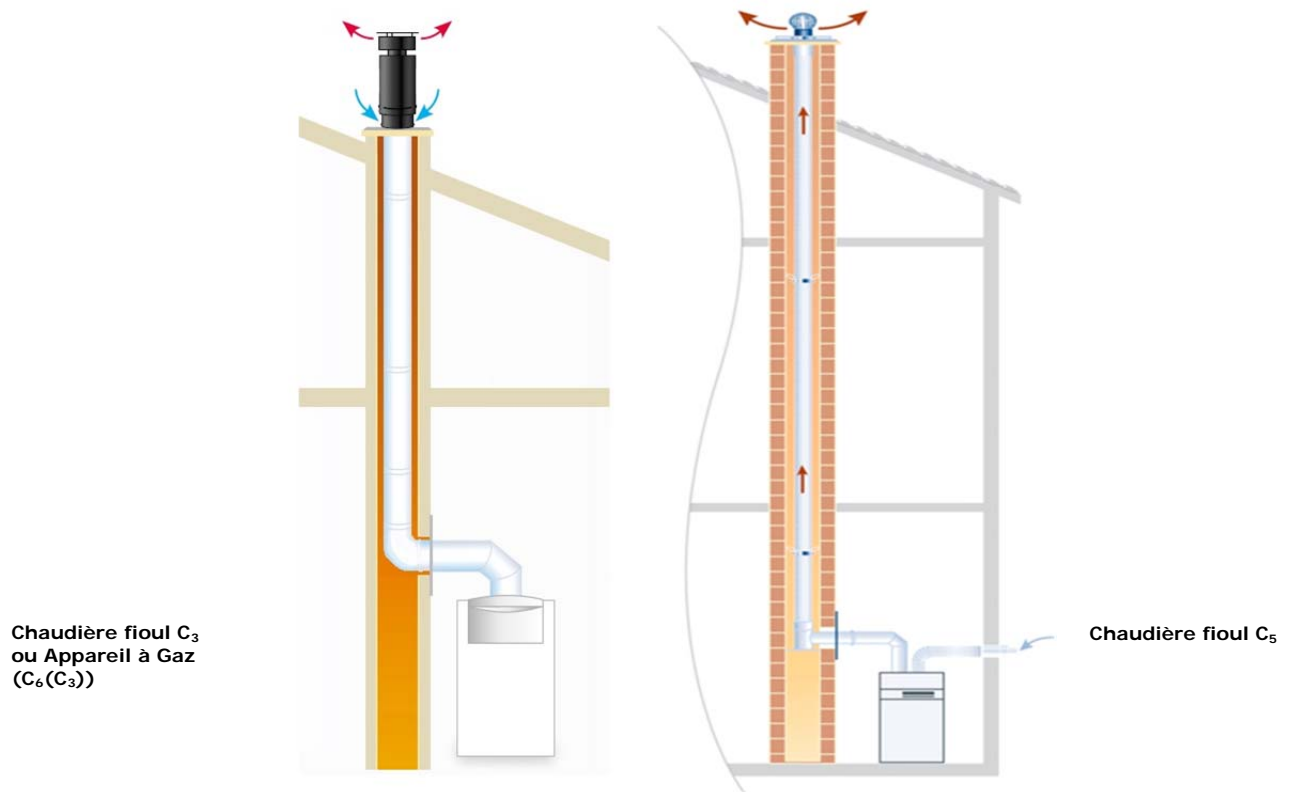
Schémas de principe pour un montage dans un conduit existant
